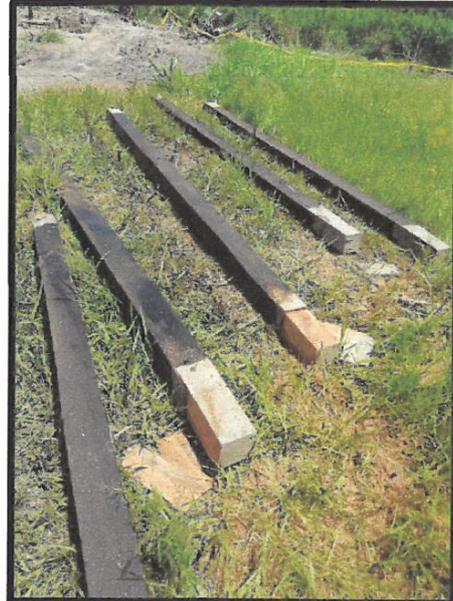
PILOTES DE MADERA DE 5 M PREVIO A SU HINCADO EN EL MODULO 4
